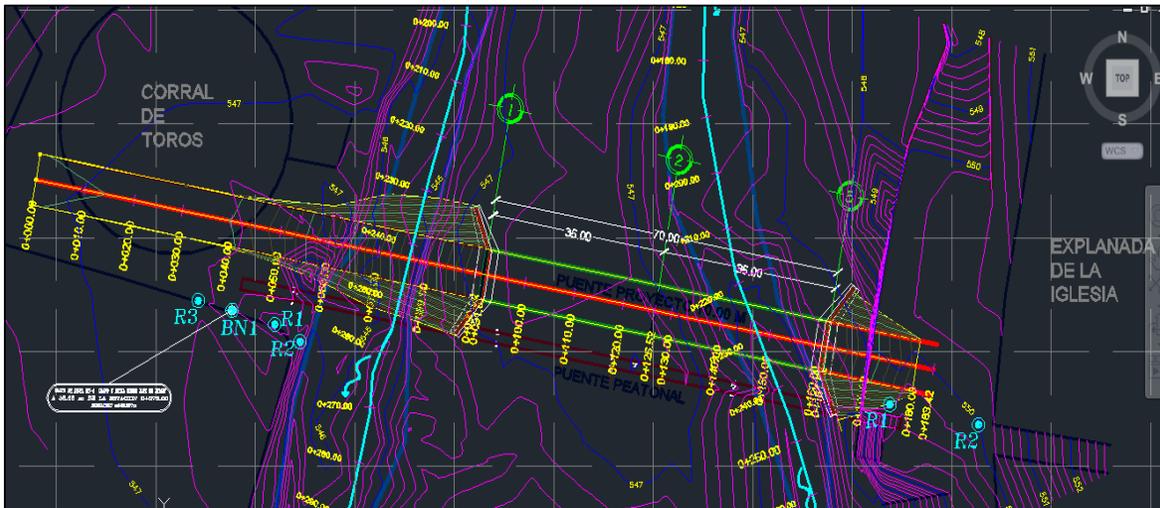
Planta general de dimensiones del Puente Vehicular Río Xaltilta
